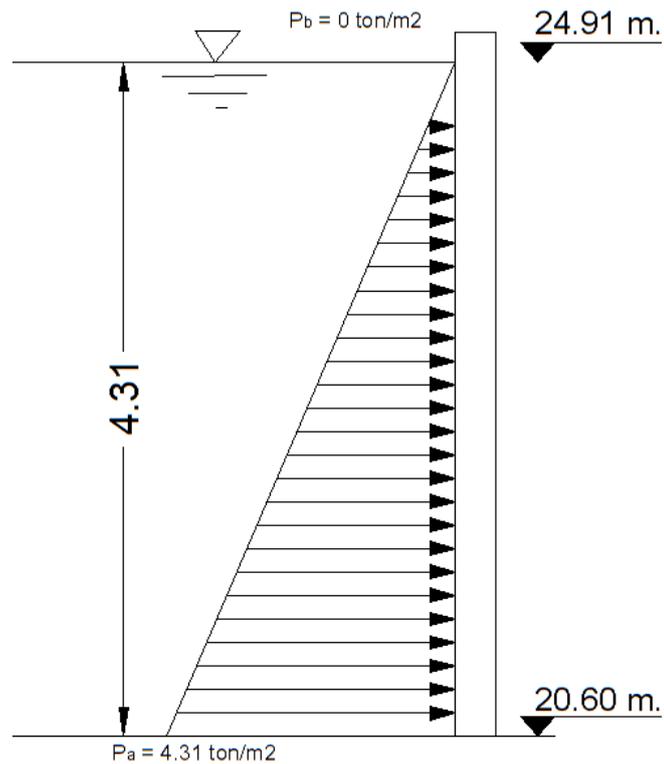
Presión en la pared cilíndrica y losa de fondo.
